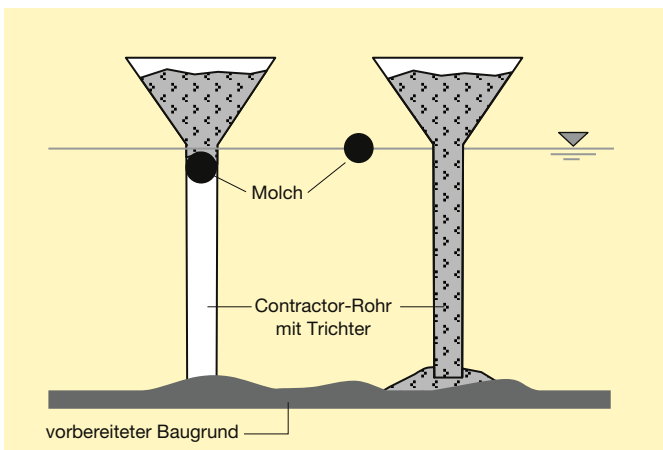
Einbauvorgang beim Betonieren mit dem Trichter und Molch
